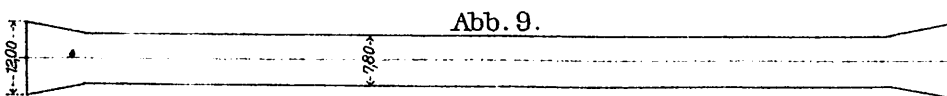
und 9. Aufriss und Grundriss.
